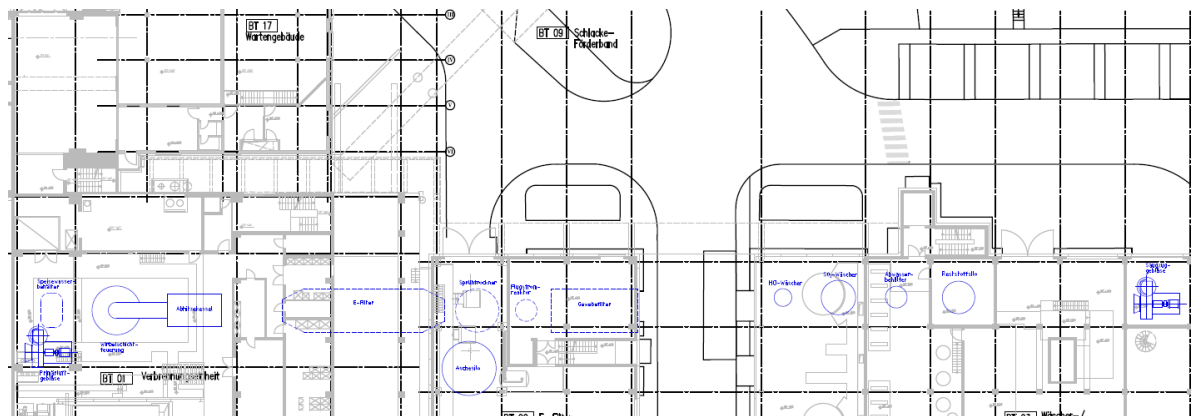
Grundriss Variante Wirbelschicht
